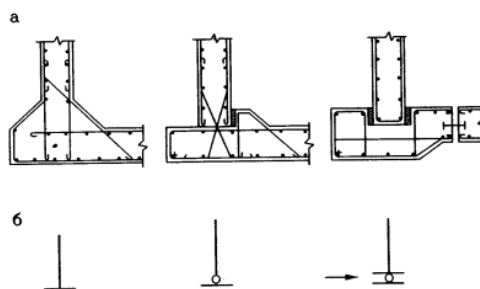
Узлы железобетонных резервуаров при соединении стен с днищем. а – конструктивные решения, б – расчетные схемы
